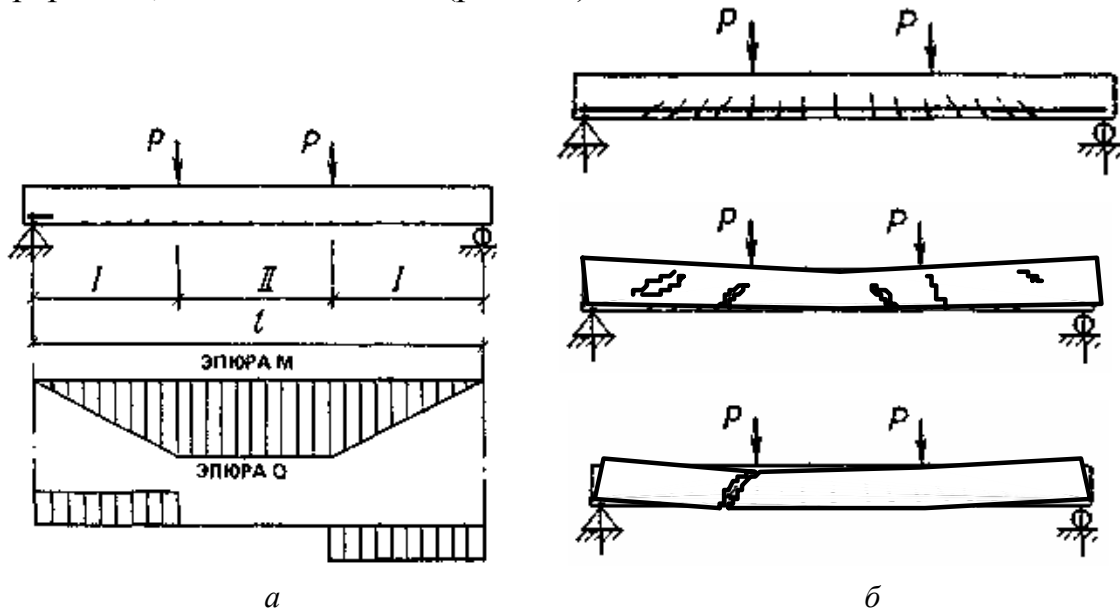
Можливі форми руйнування залізобетонної балки при згині:
